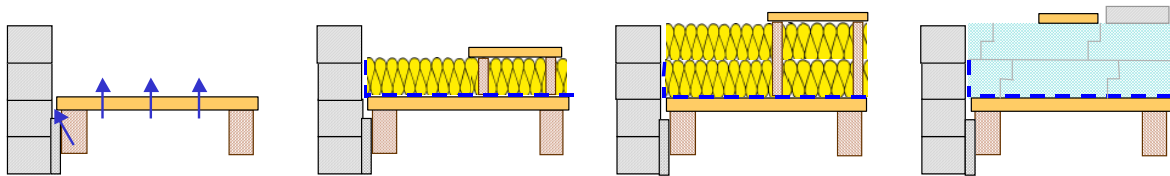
Sichtbalken-, Kehlbalkendecken, Sanierungsvarianten von oben
